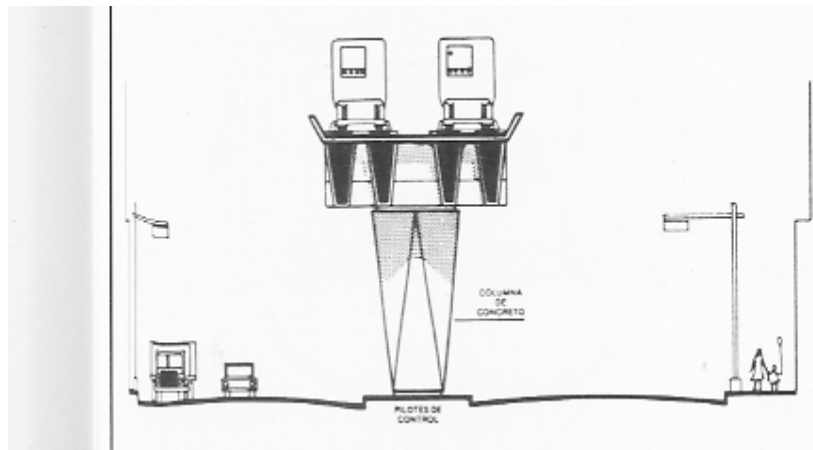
COLUMNAS QUE SOSTIENEN LAS ESTRUCTURAS ELEVADAS DE LA LÍNEA 4.
